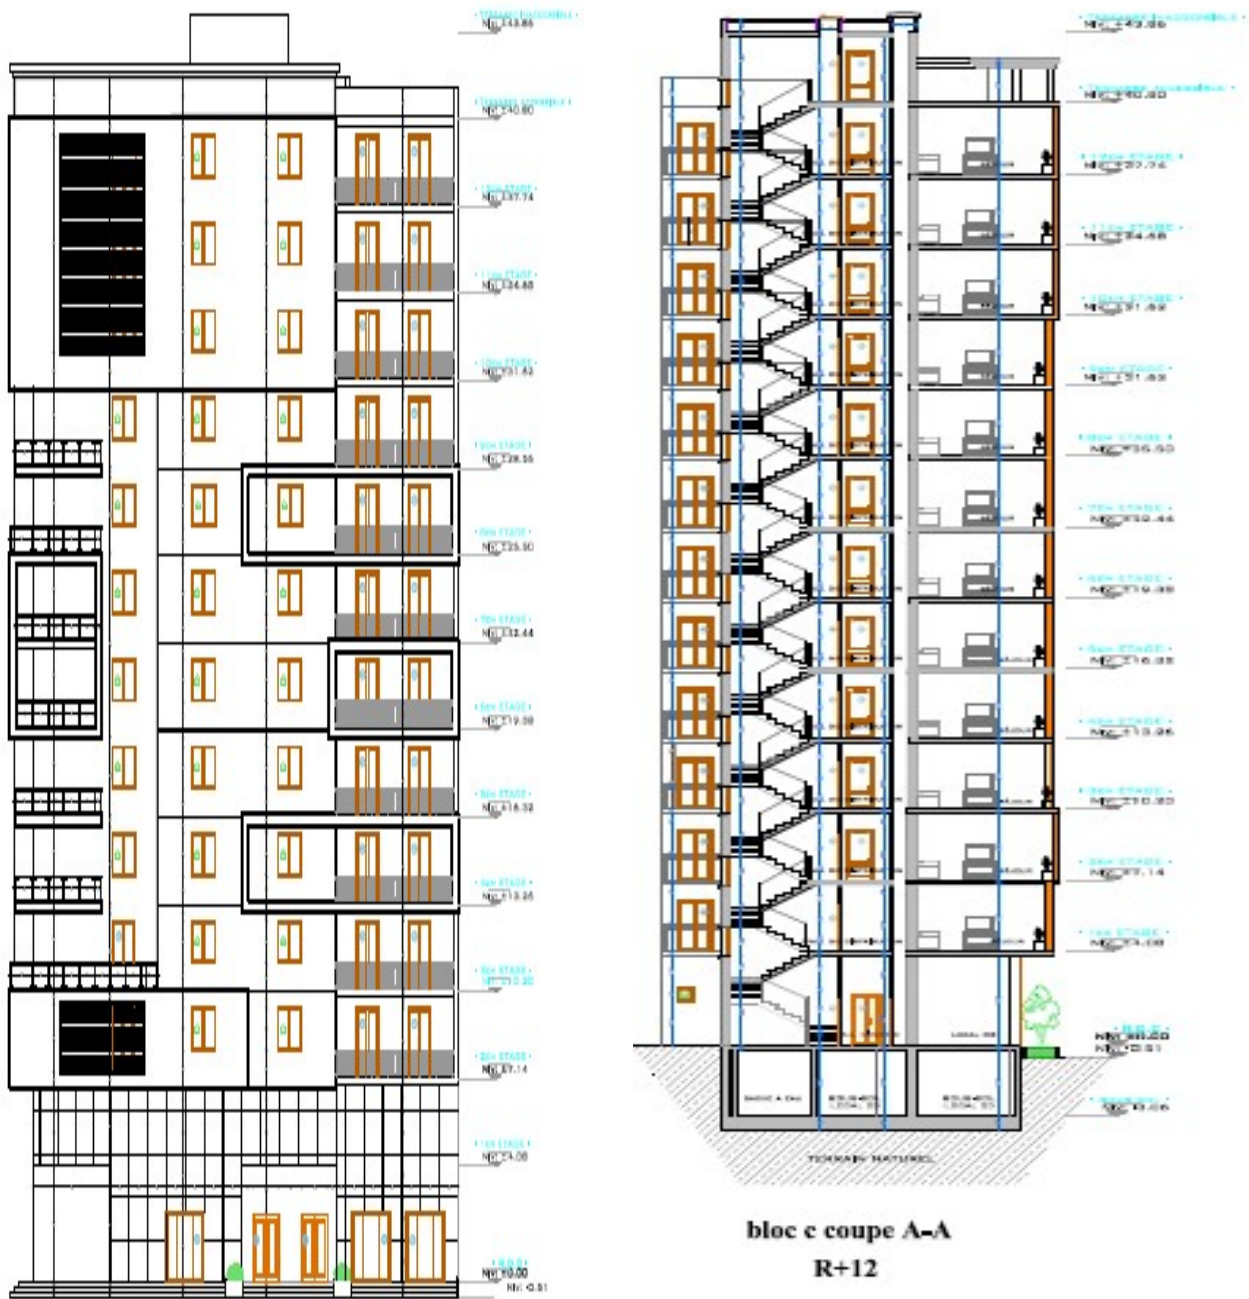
vue en plan de la façade principale de la structure et coupe A-A de la structure
